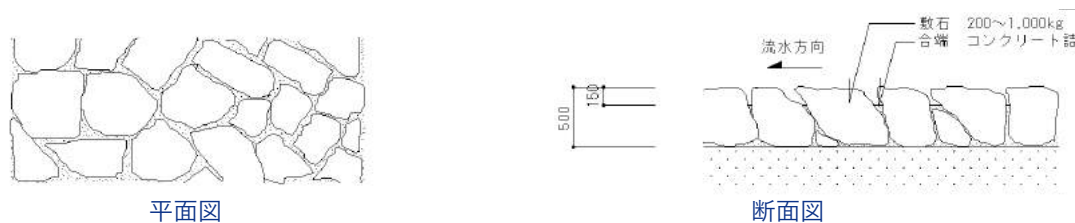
護床工平面図、断面図（出典：究極の名橋 錦帯橋）
